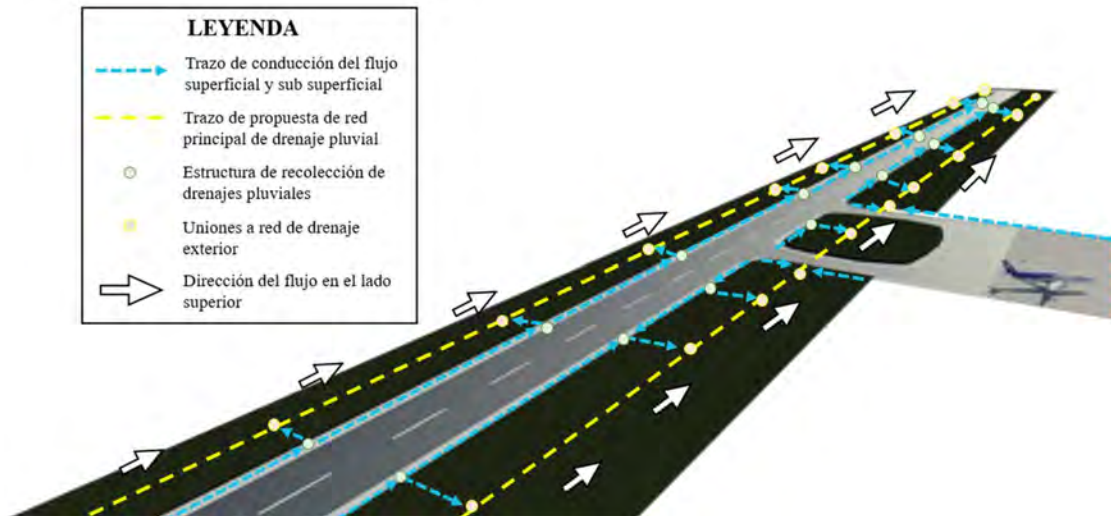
Esquema general de la red de drenaje superficial a la red de drenaje exterior
